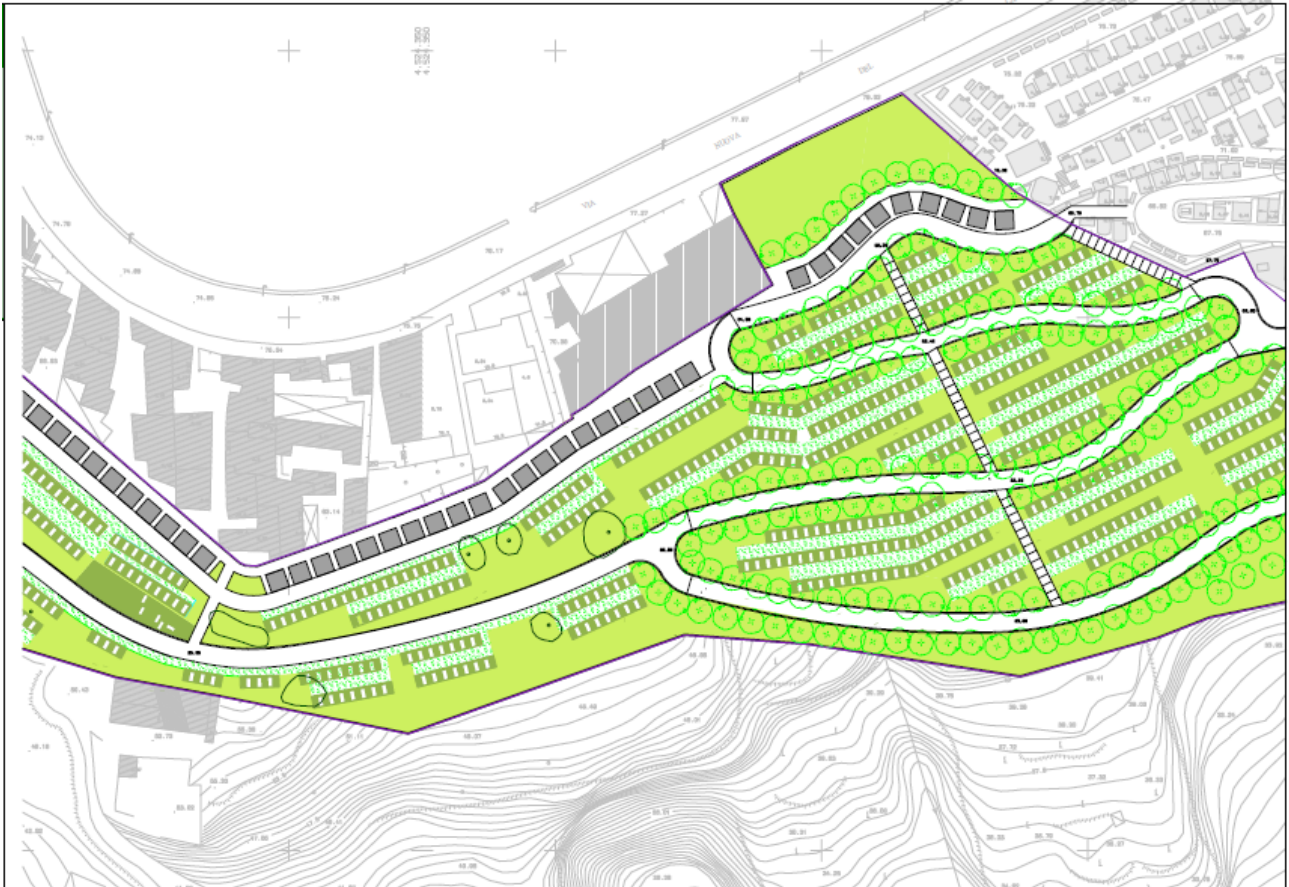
Progetto Preliminare - Pianta Area tra di collegamento tra ex colerici e Santa Maria del pianto Elaborato PR_AR_004.02
